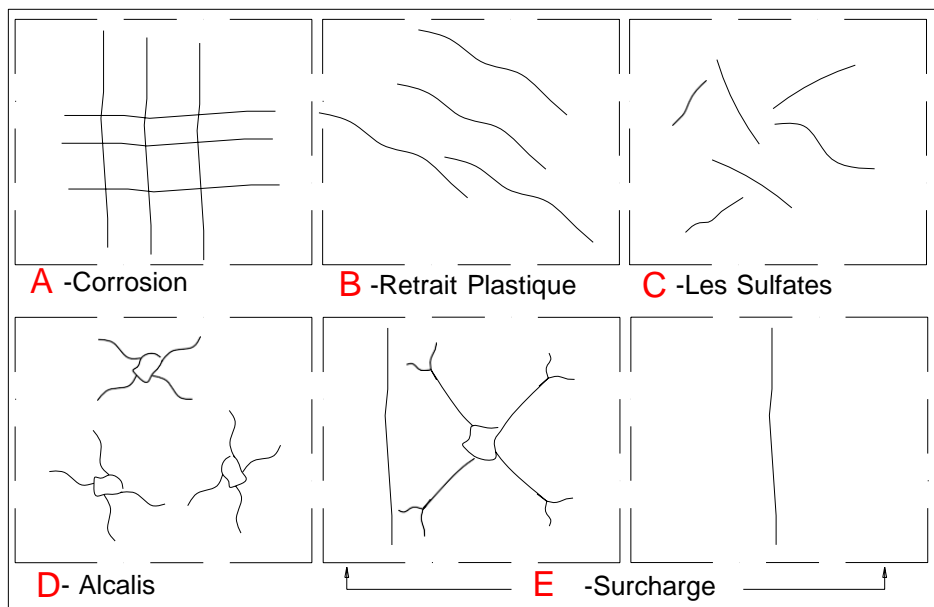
Fissures probables affectant les plancher. [1]
